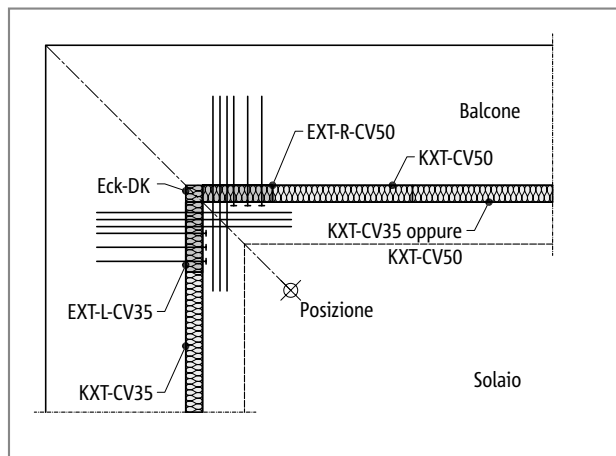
Schöck Isokorb® tipo EXT: balcone con angolo esterno a sbalzo (impiego EXT-L-CV35, EXT-R-CV50)
